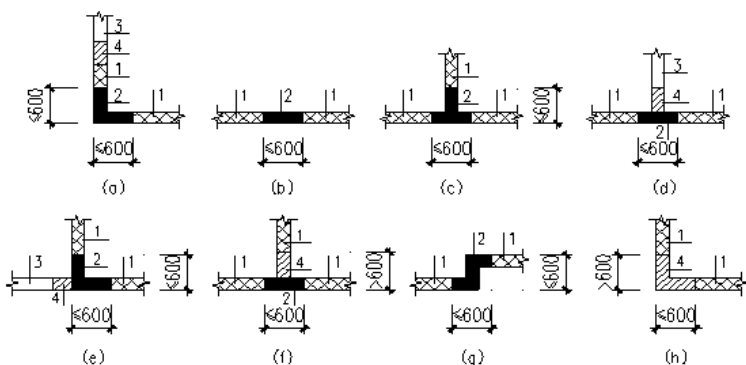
预制剪力墙板间可计入预制混凝土体积的现浇段示意图
